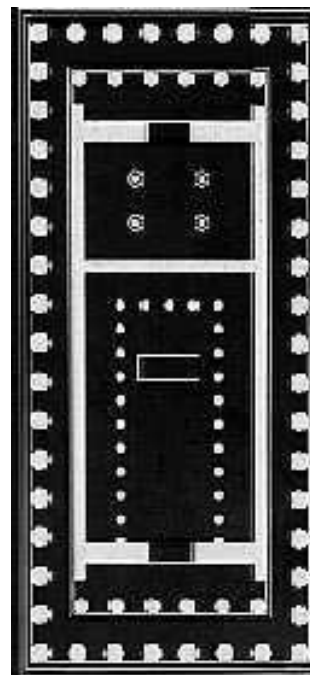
Planta Baixa - Pártenon do mundo (Figuras 7 a 10). Fonte: Centros 5
